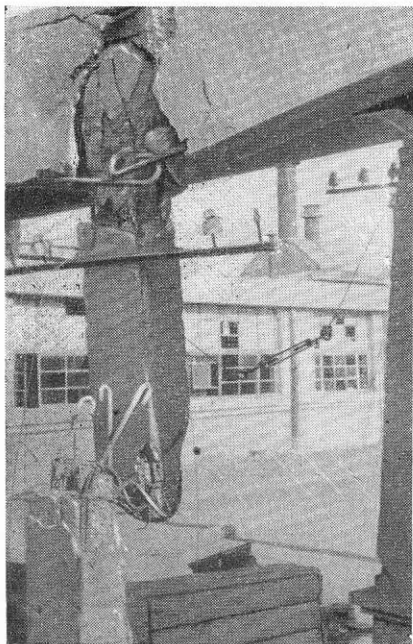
Повреждение железобетонных стоек и прогонов переходного мостика
